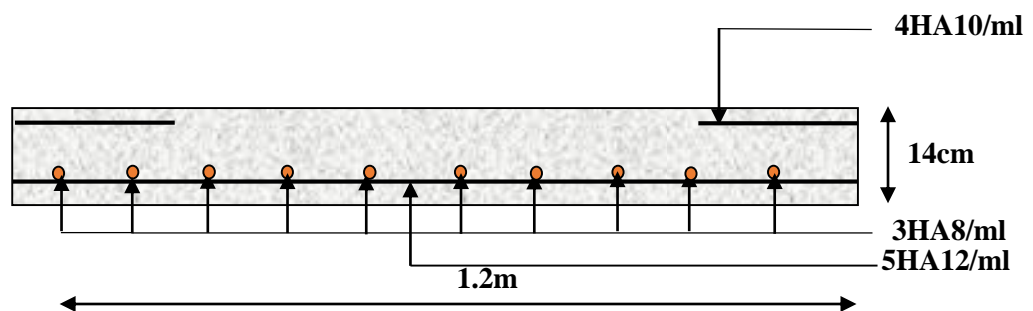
Schéma de ferrailage de la dalle pleine type N° 1.
